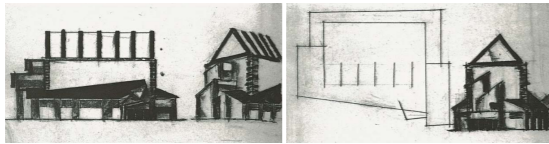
某公共建筑，立面图、透视图、平面图，1920 年
